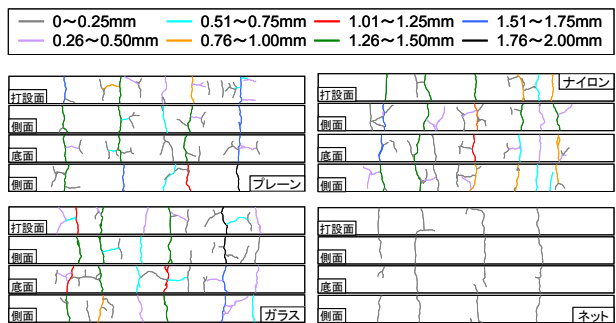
ひび割れ状況の一例 (シリーズ II, 10×10cm)
